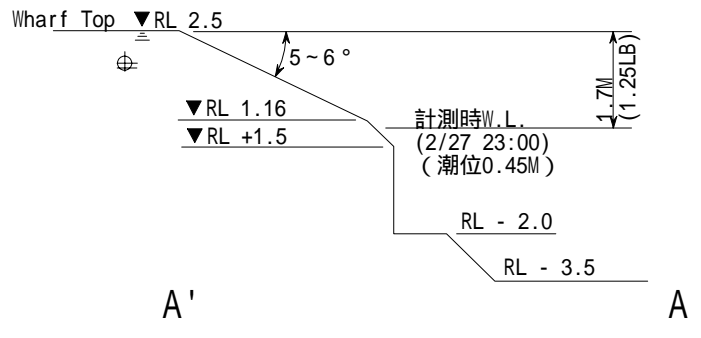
ハアフェバ埠頭断面図 (A-A' 断面)
